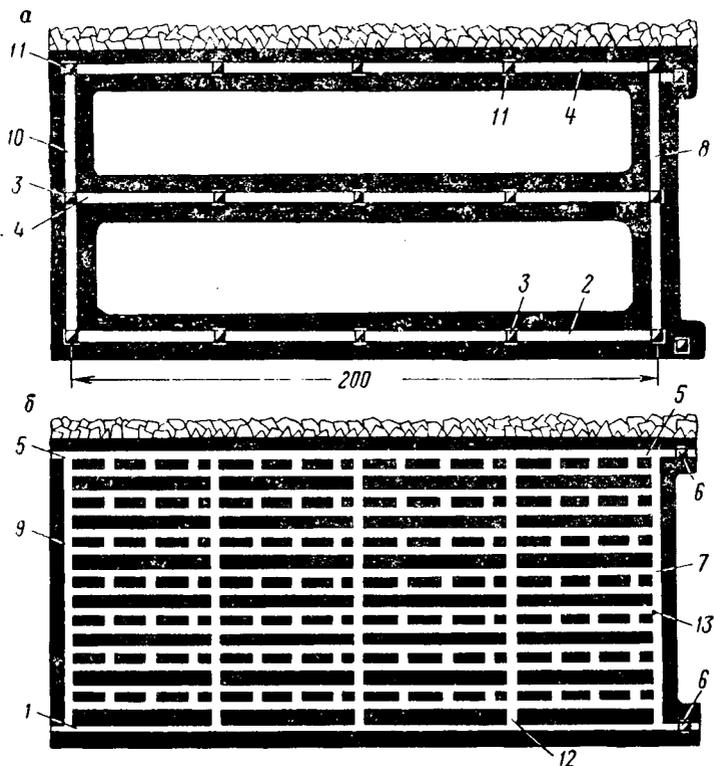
Комбинированная система разработки подэтажами с гибким перекрытием:
